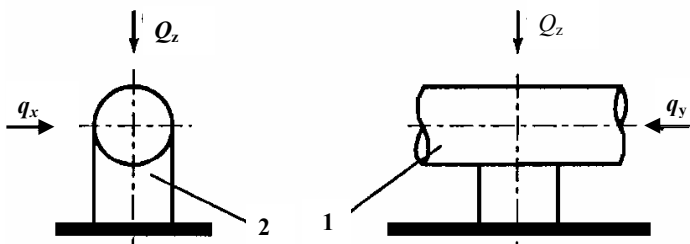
Схема нагрузок на опору: q_x – боковая составляющая силы трения; q_y – продольная составляющая силы трения; Q_z – вертикальное давление трубопровода на подвижную опору; 1 – труба; 2 – подвижная опора
